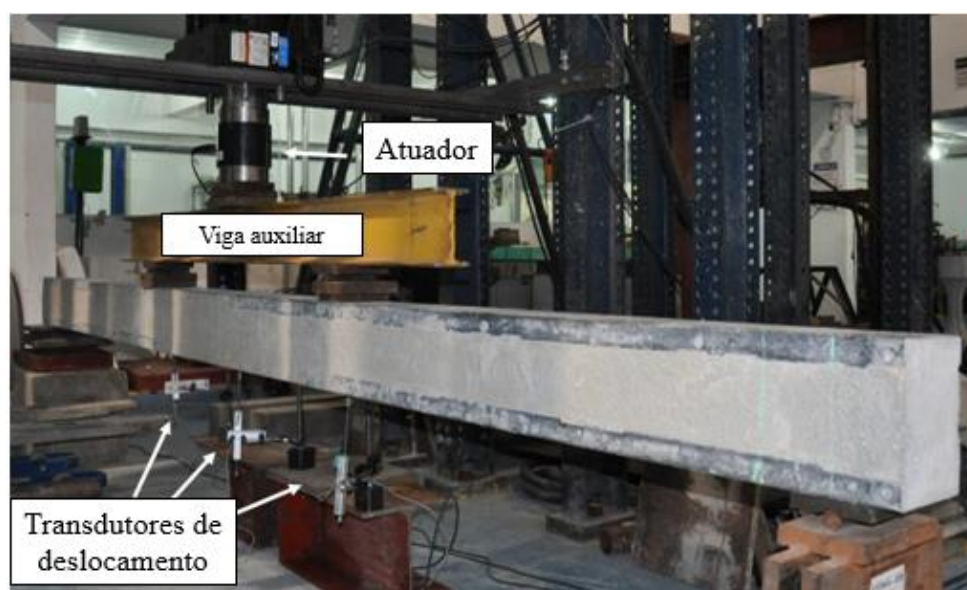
Sistema dos ensaios de flexão a quatro pontos, indicando a utilização de viga auxiliar para carregamento em dois pontos.
